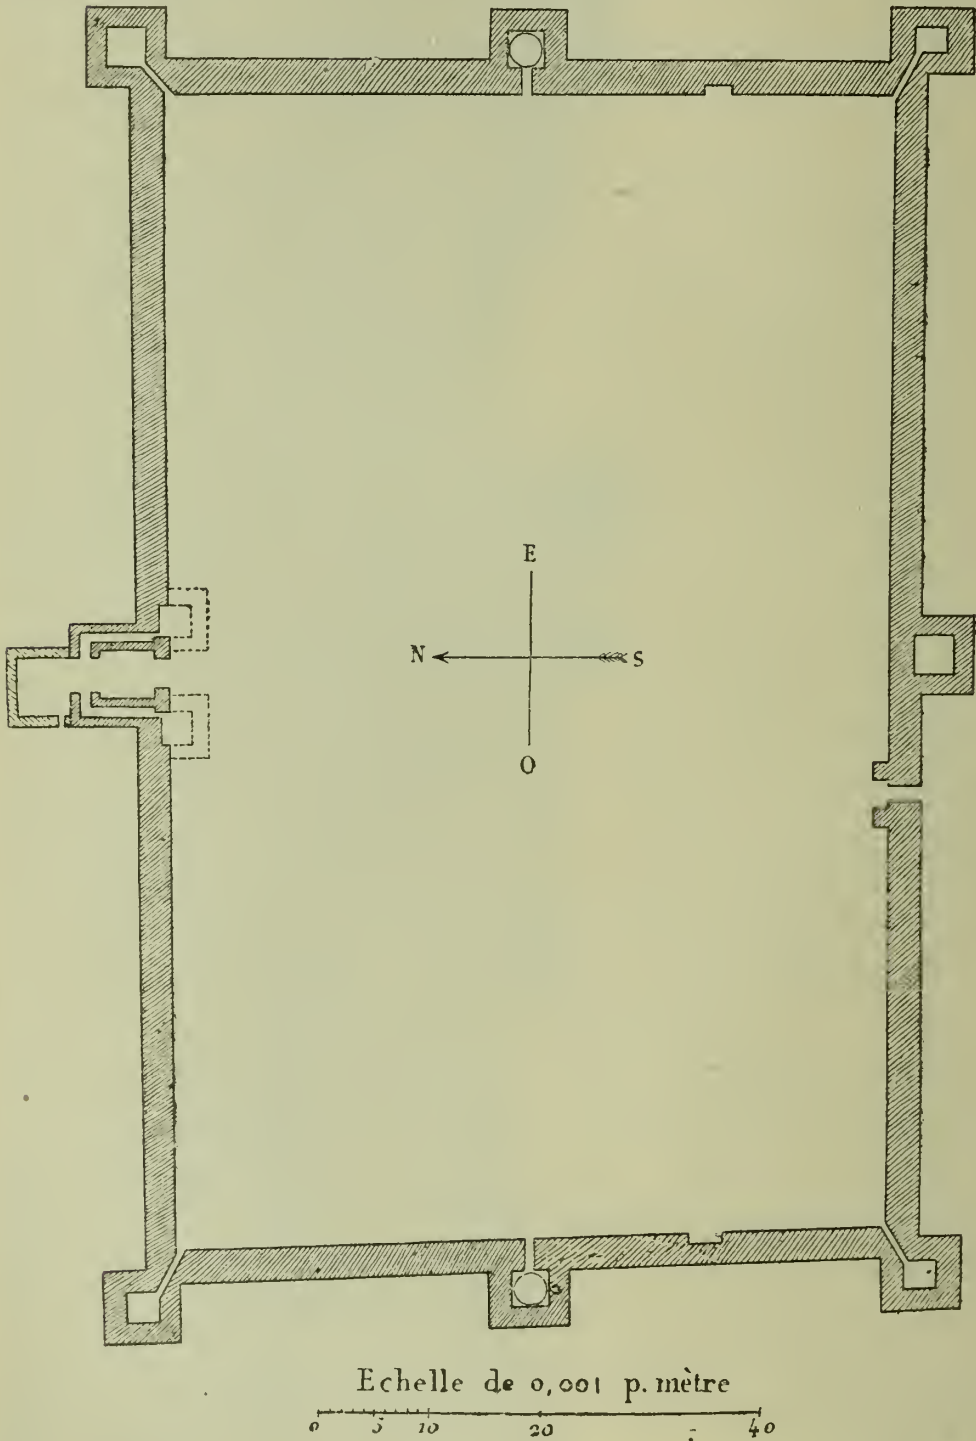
Timgad. Plan de la forteresse byzantine.
